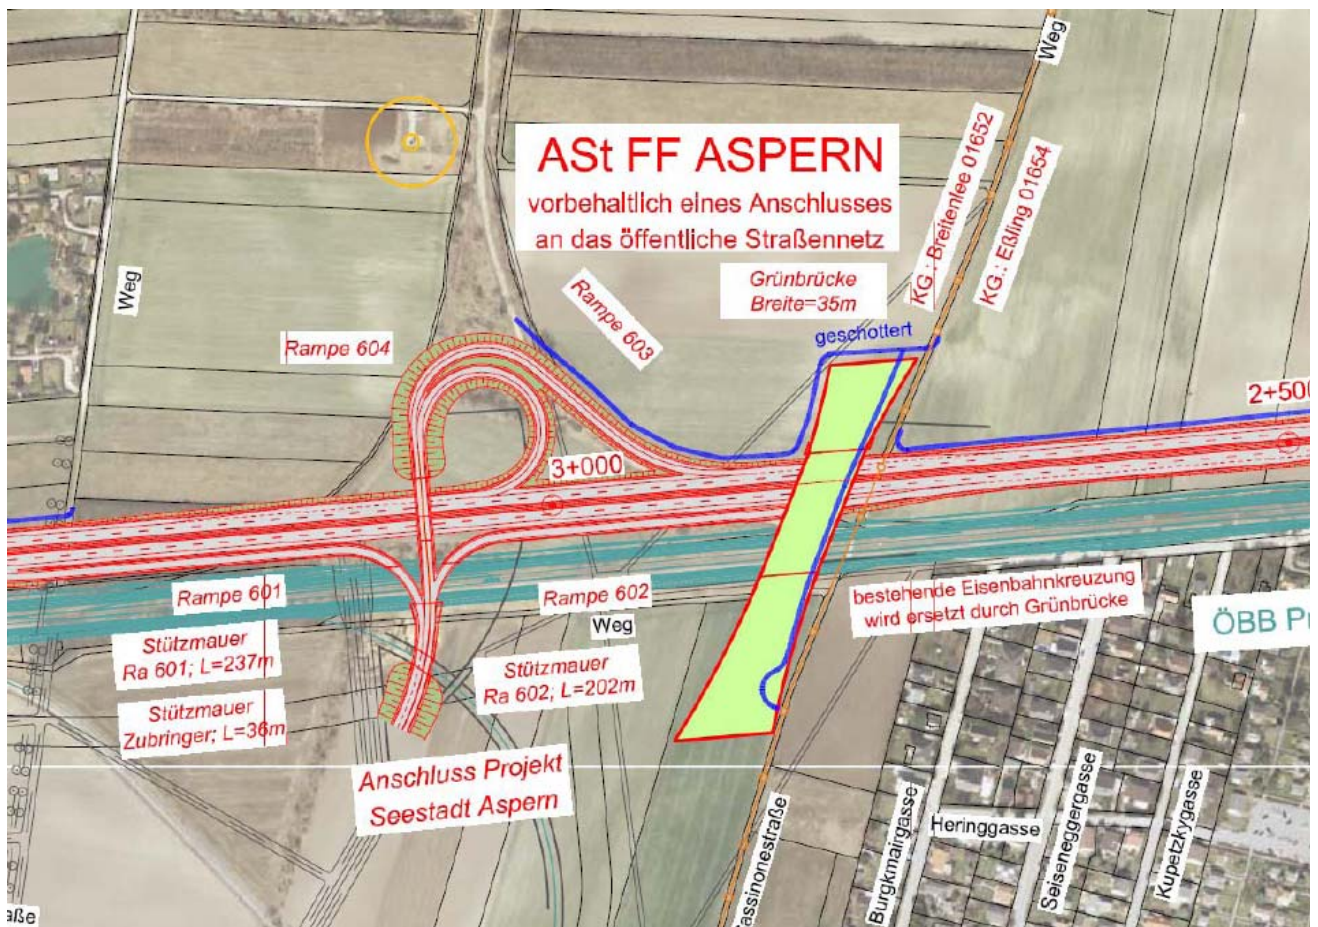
Ausschnitt Lageplan – Technisches Projekt, Einreichprojekt S 1 Spange, Quelle: Werner Consult / IKK
